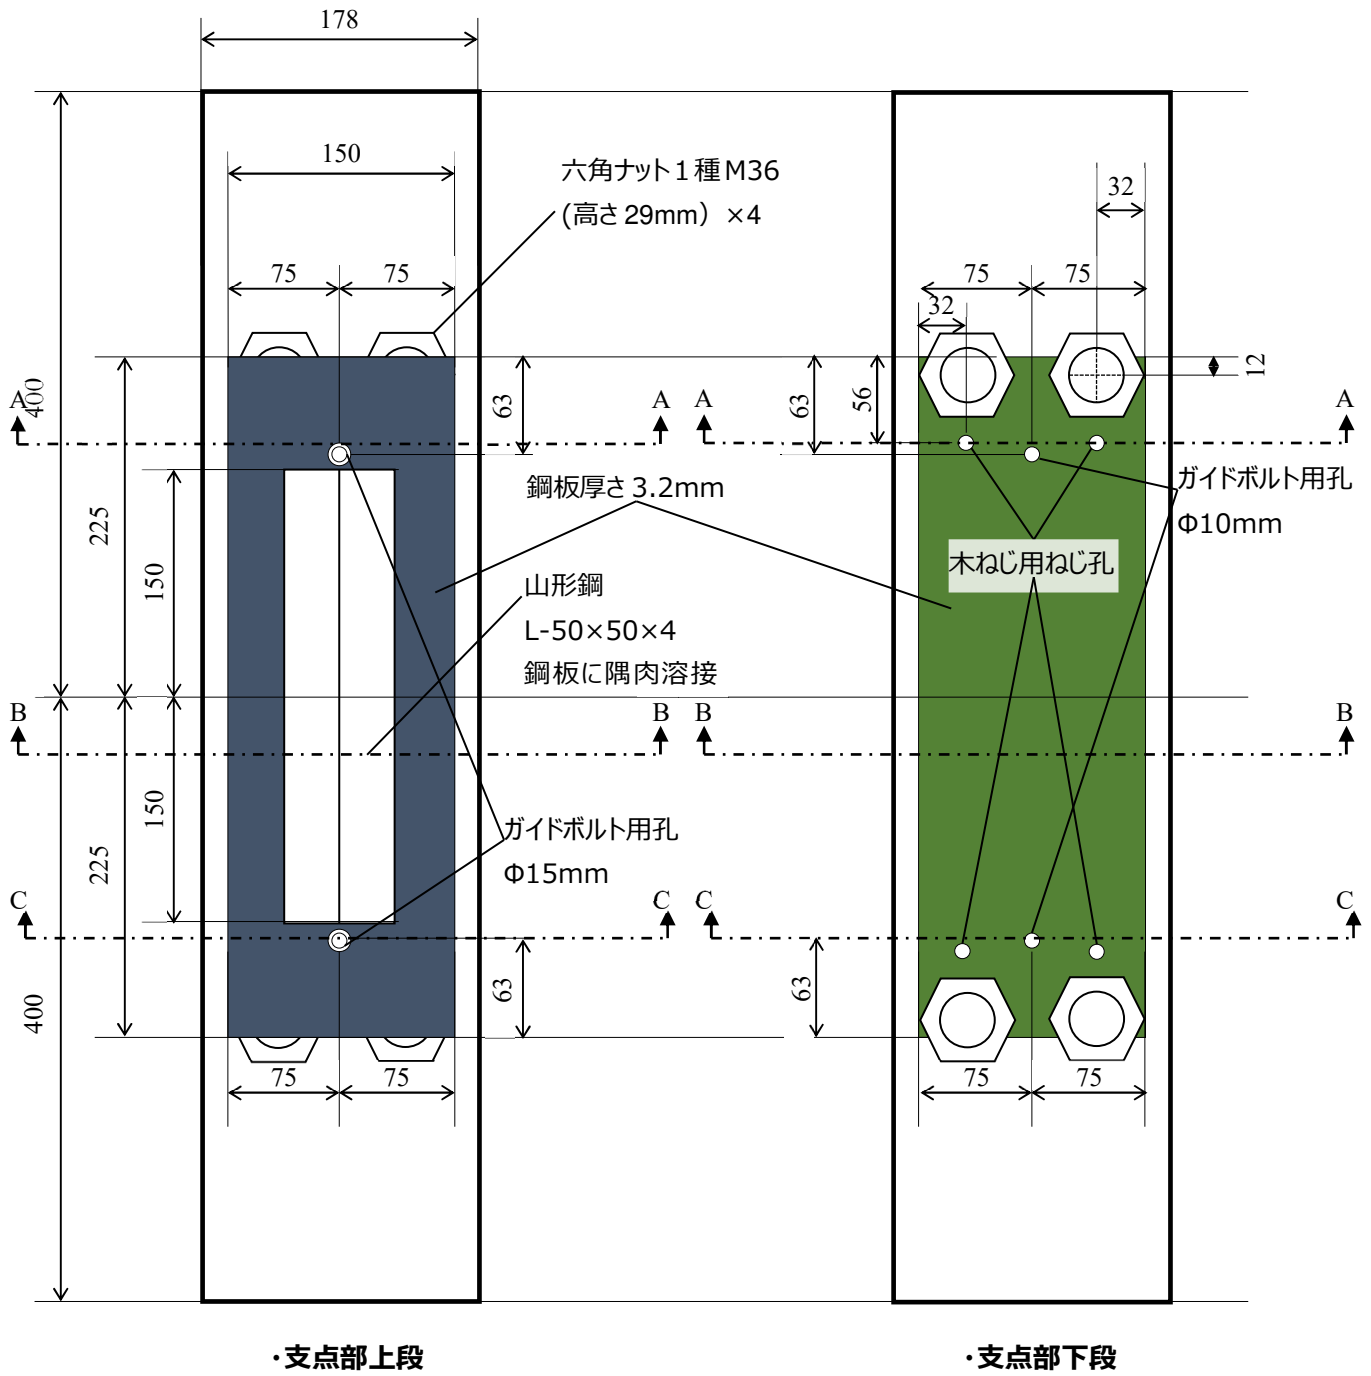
Rb 支点付近平面詳細図 (単位 : mm)
